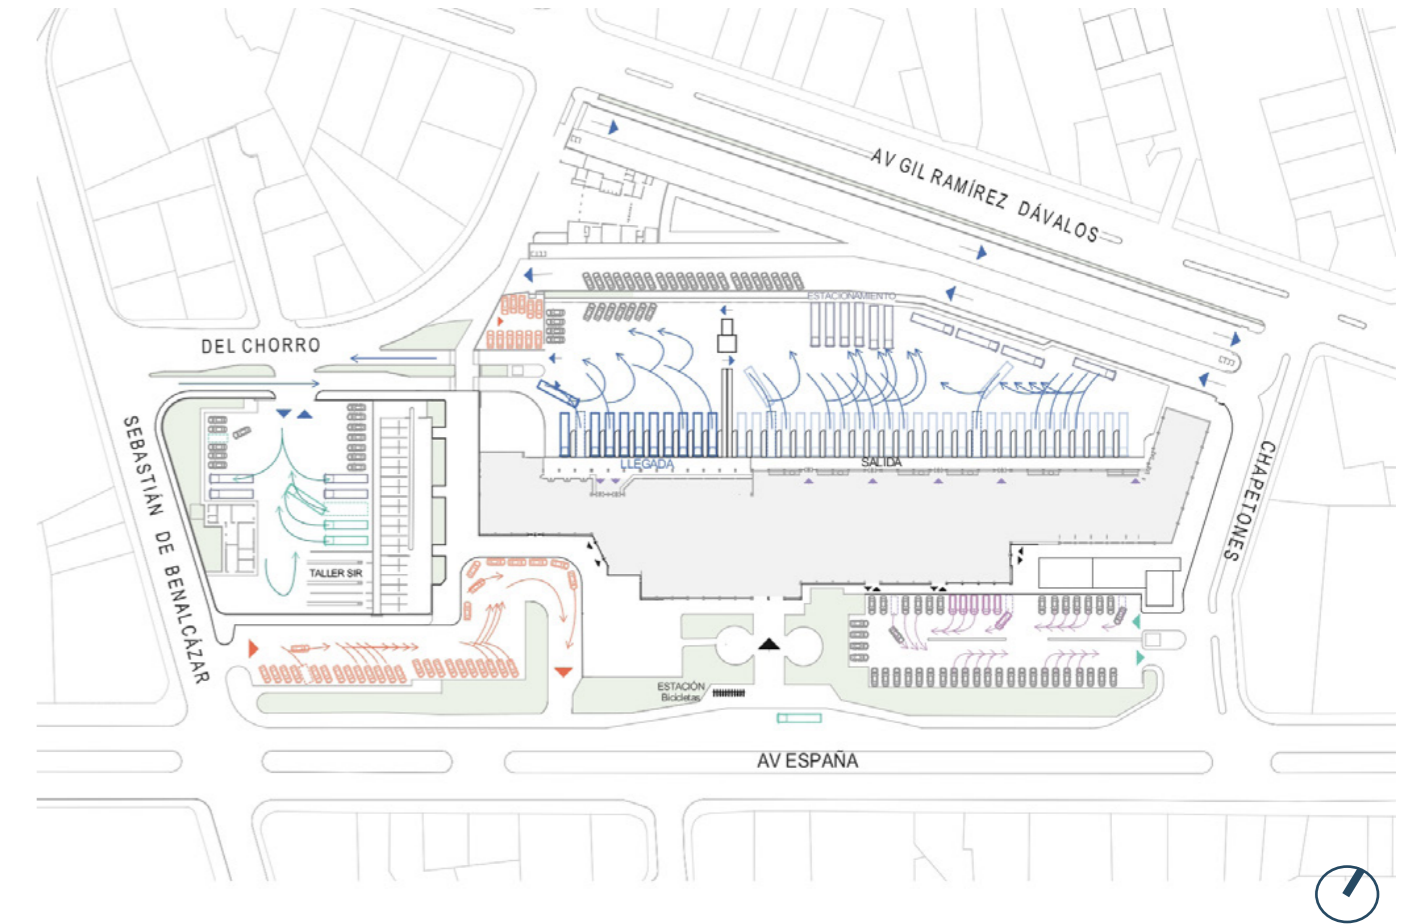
Plano ángulo de giro dentro de los parqueaderos del Terminal Terrestre de Cuenca. Fuente propia
